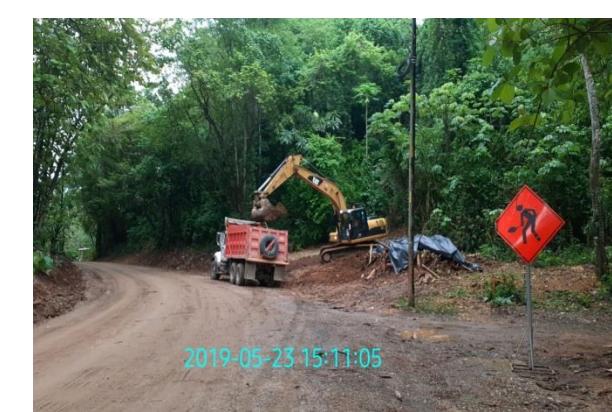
Avance en la construcción de cunetas trapezoidales.
